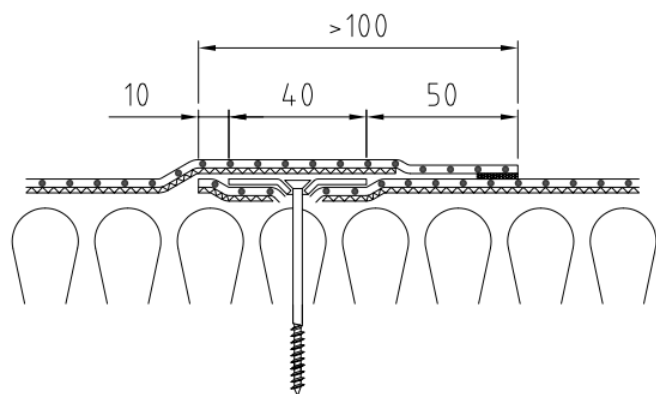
Joints longitudinaux en cas de système fixé mécaniquement
